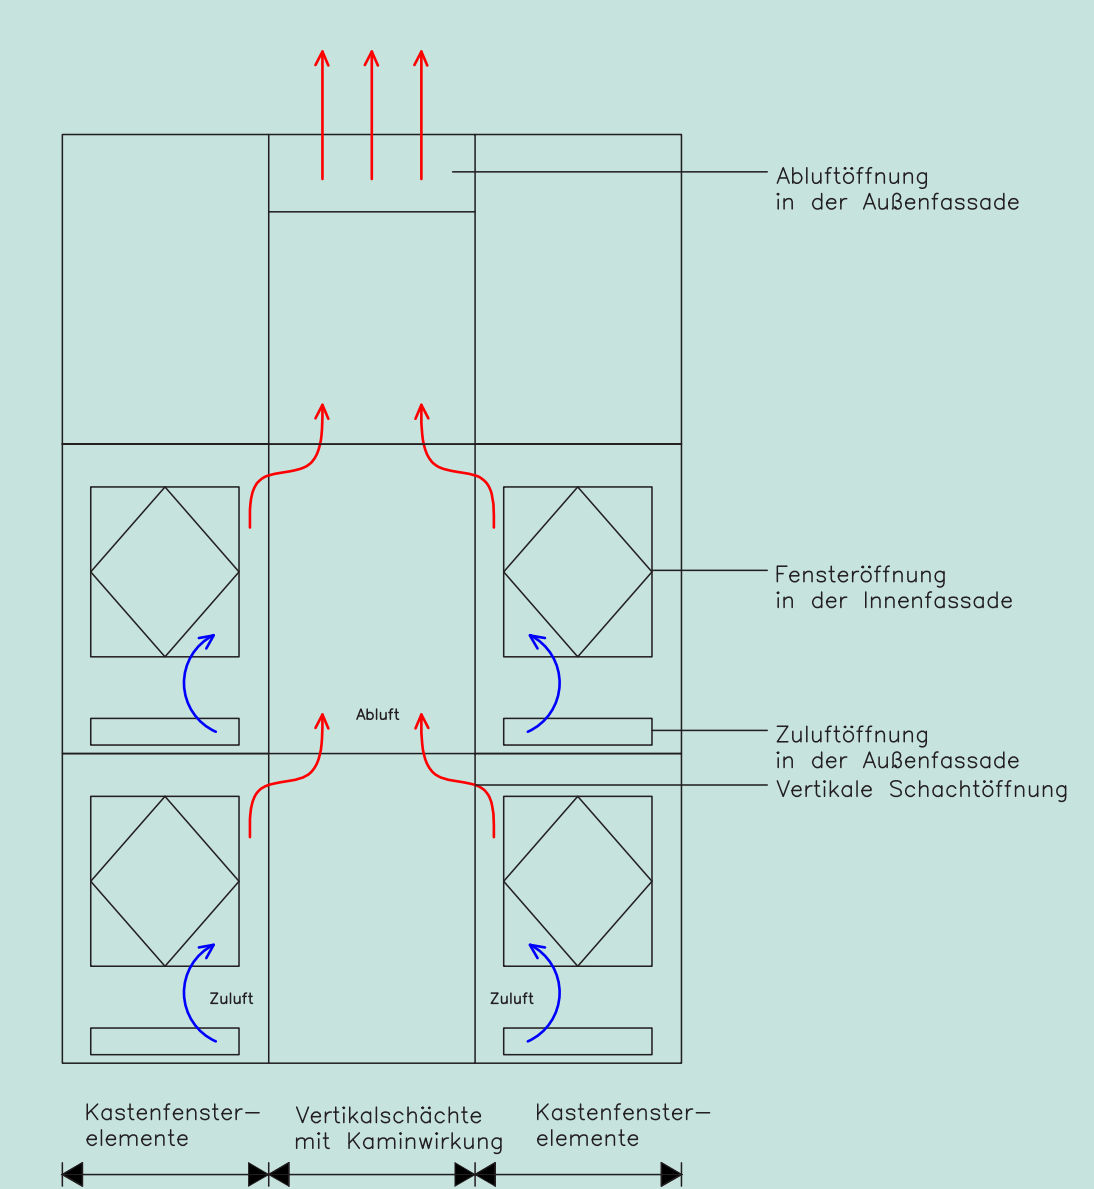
Lüftungsprinzip einer Schacht-Kasten-Fassade
